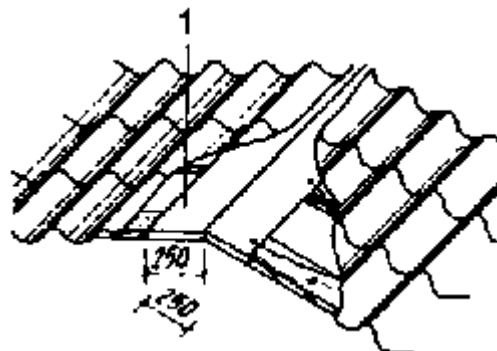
Недостаточно крутой уклон кровли и отсутствие надежных фартуков приводит к протечкам кровельного покрытия:1 - жесь.
